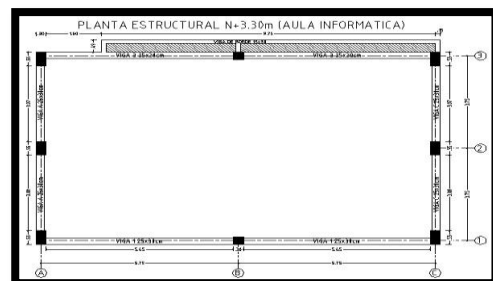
Planta estructural cubierta del Bloque de sistemas.
